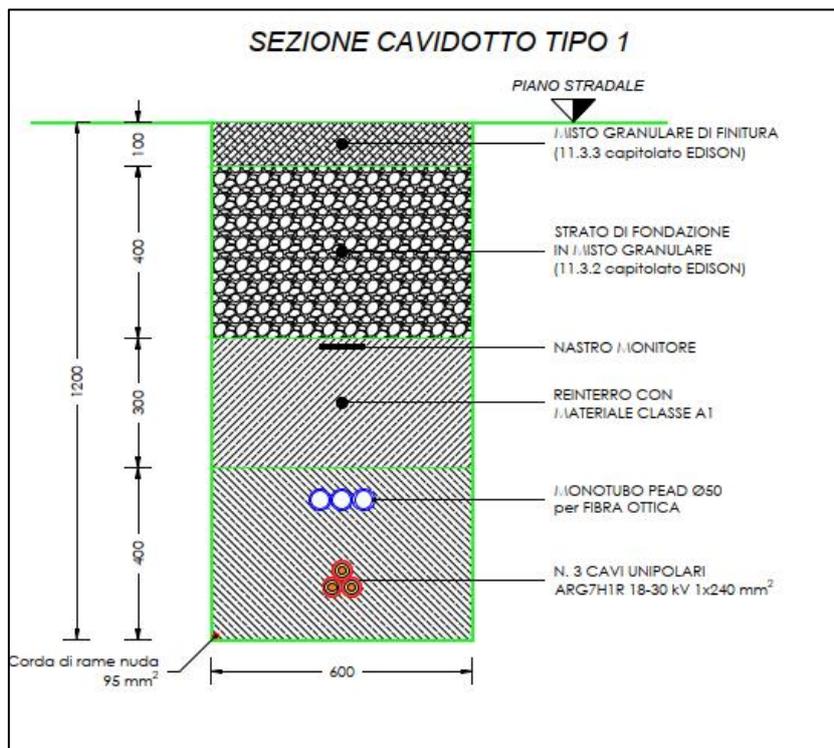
Elettrodotto MT - Sezione di Scavo Tipo 1
